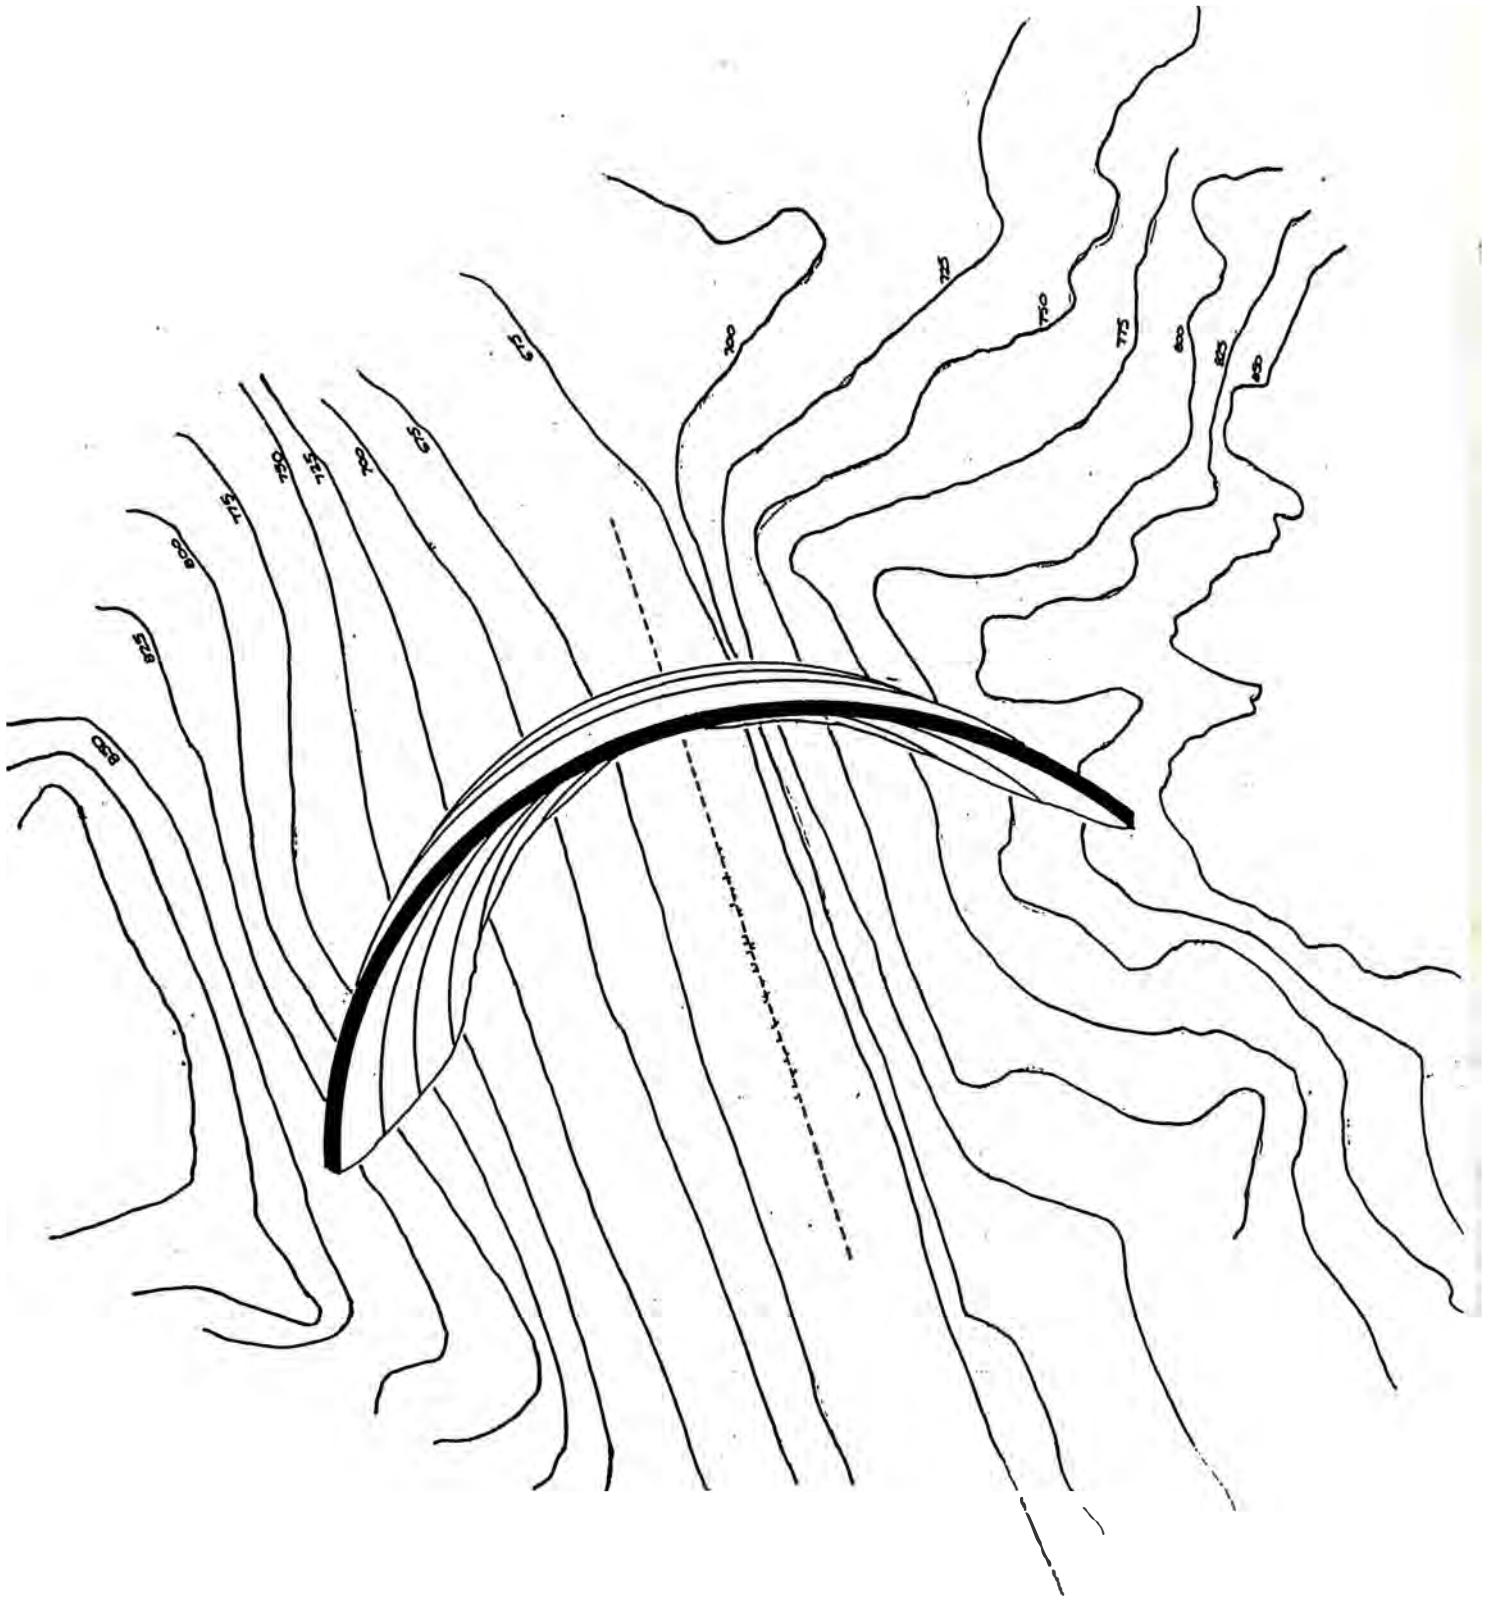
Planta para la alternativa final de la presa Chadín 2
